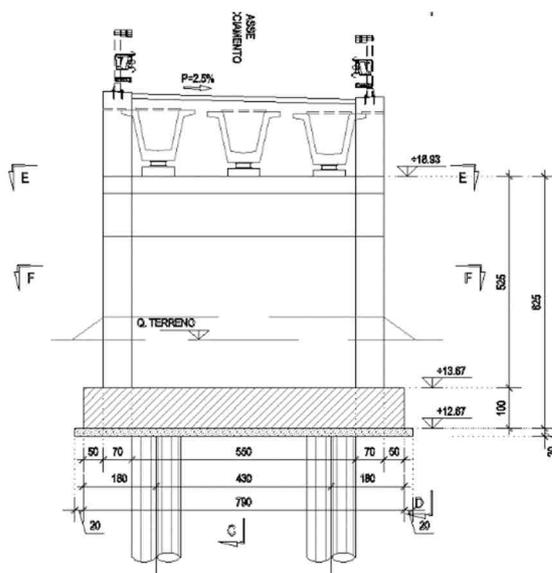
Spalla B prospetto Ponte Rio Nou su viabilità S05
